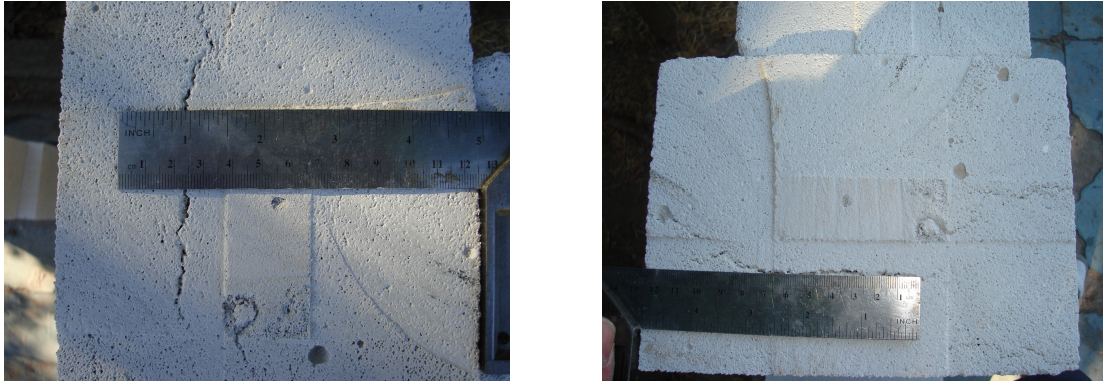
Bloques fisurados por falla de proceso
